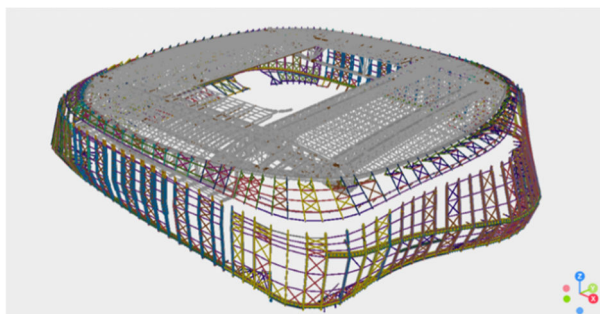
Modelo IFC: Fachada y cubierta. Vista desde S-E
